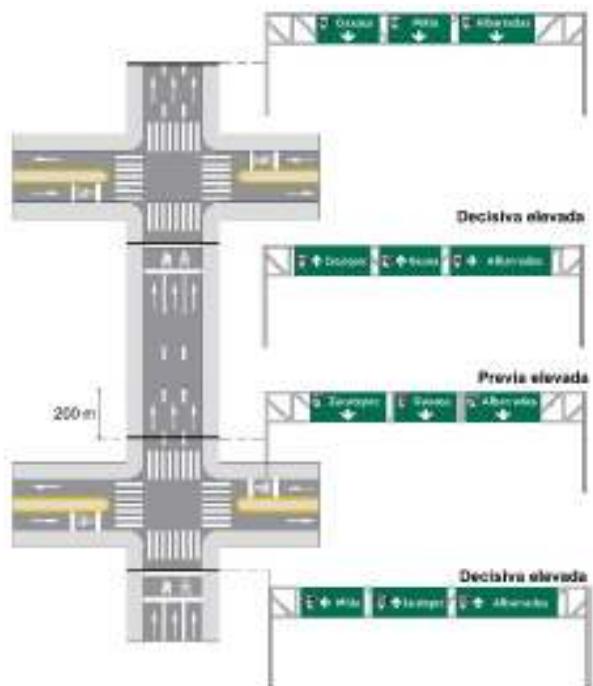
46 Colocación de señales tipo puente en vías con giros a la derecha e izquierda
